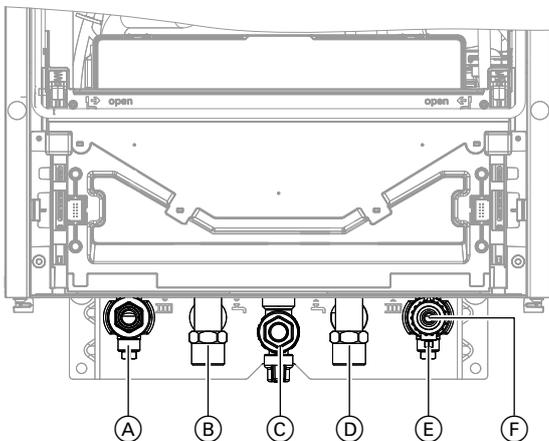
Gewindeangaben in Verbindung mit Anschlusszubehör
